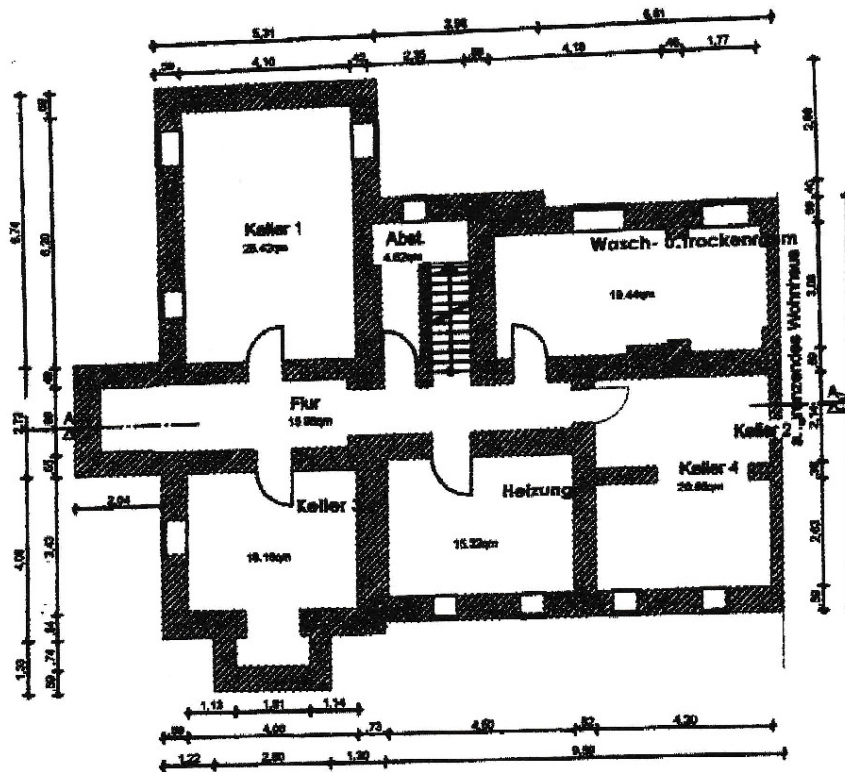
Grundriss Kellergeschoß, Hostatostrasse 26, 65929 Frankfurt am Main
